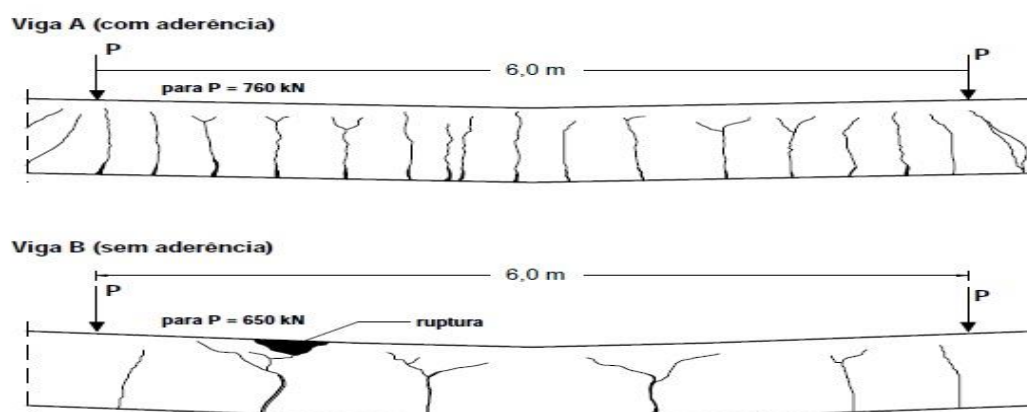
Configuração das fissuras ao ser atingida a carga limite
